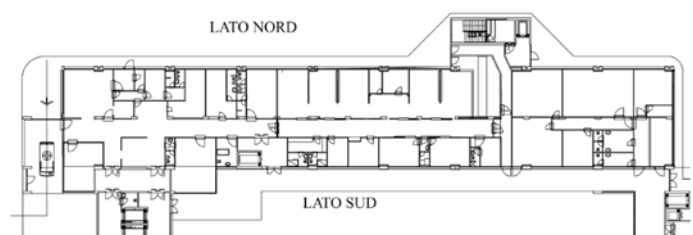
Pianta architettonica del primo piano del Padiglione Chirurgia allo stato di progetto
